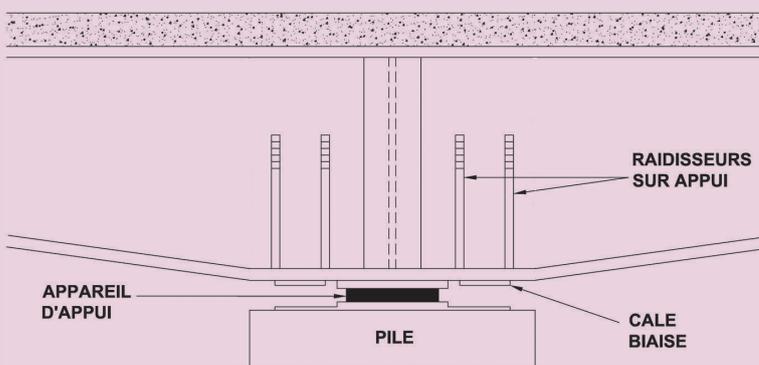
Zone sur appui d'un tablier de hauteur variable
